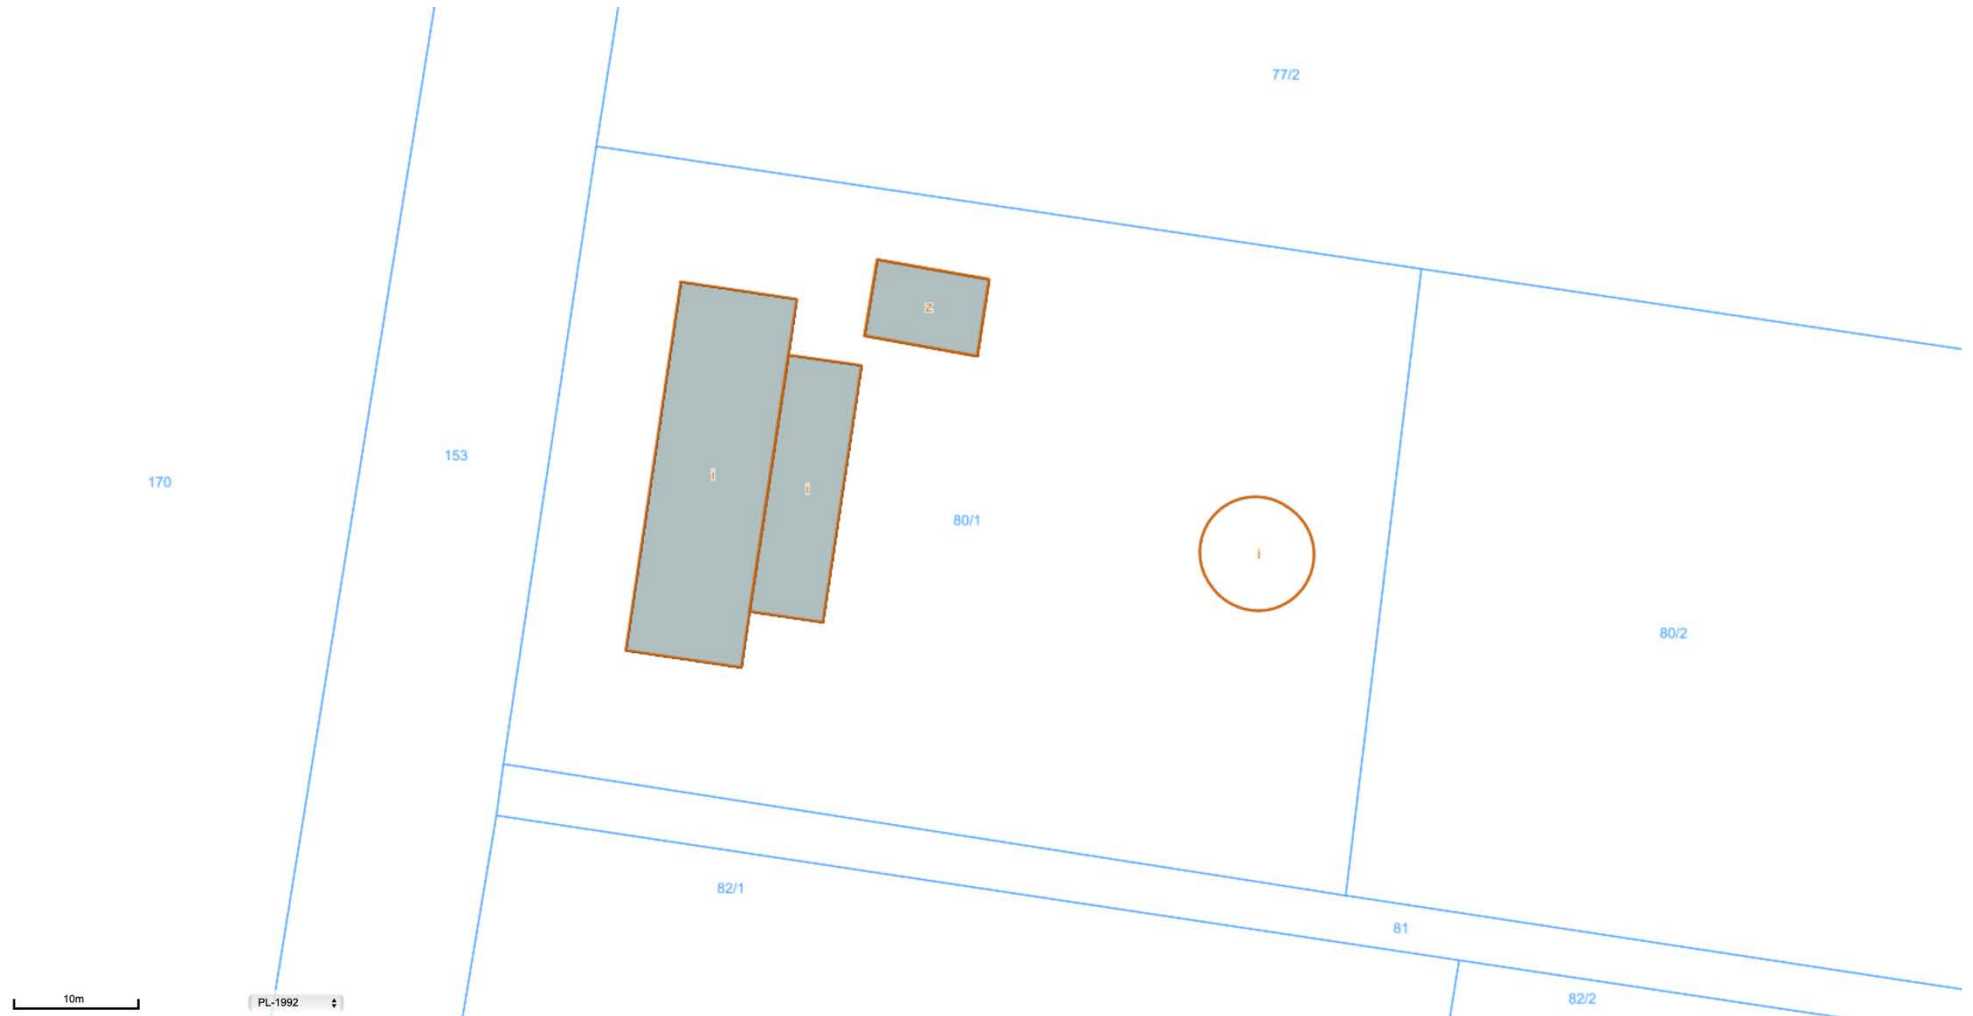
Stacja uzdatniania wody w Biernacicach – miejsce montażu instalacji fotowoltaicznej (dach)
